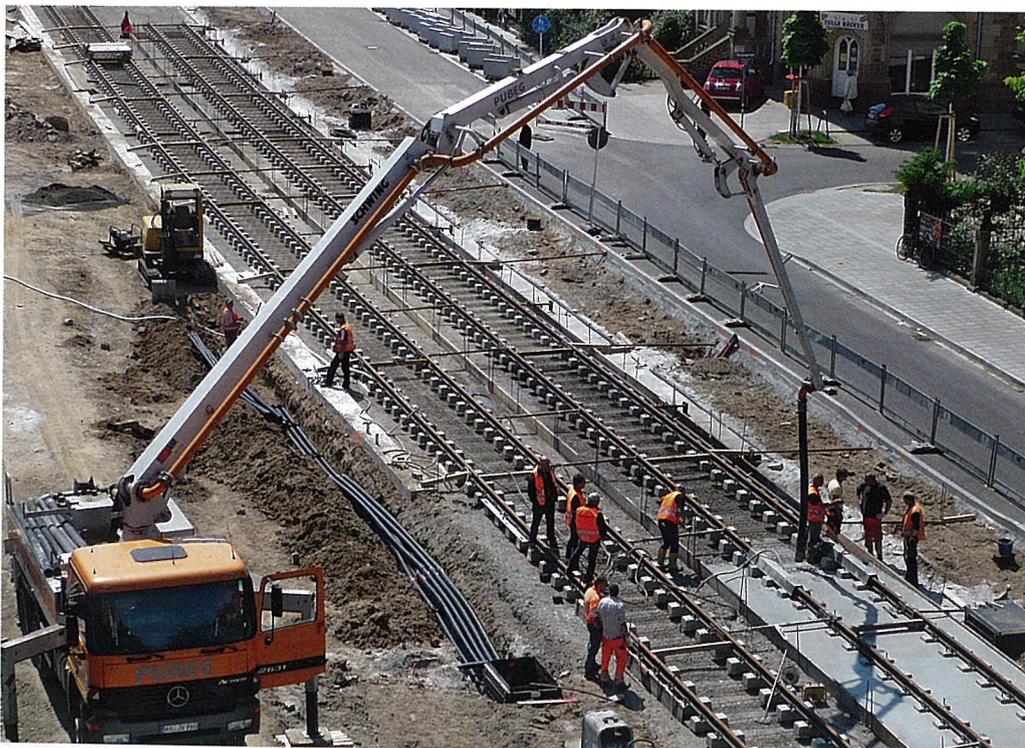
Betonage des Gleisrostes ohne durchgehende Längsbewehrung.
